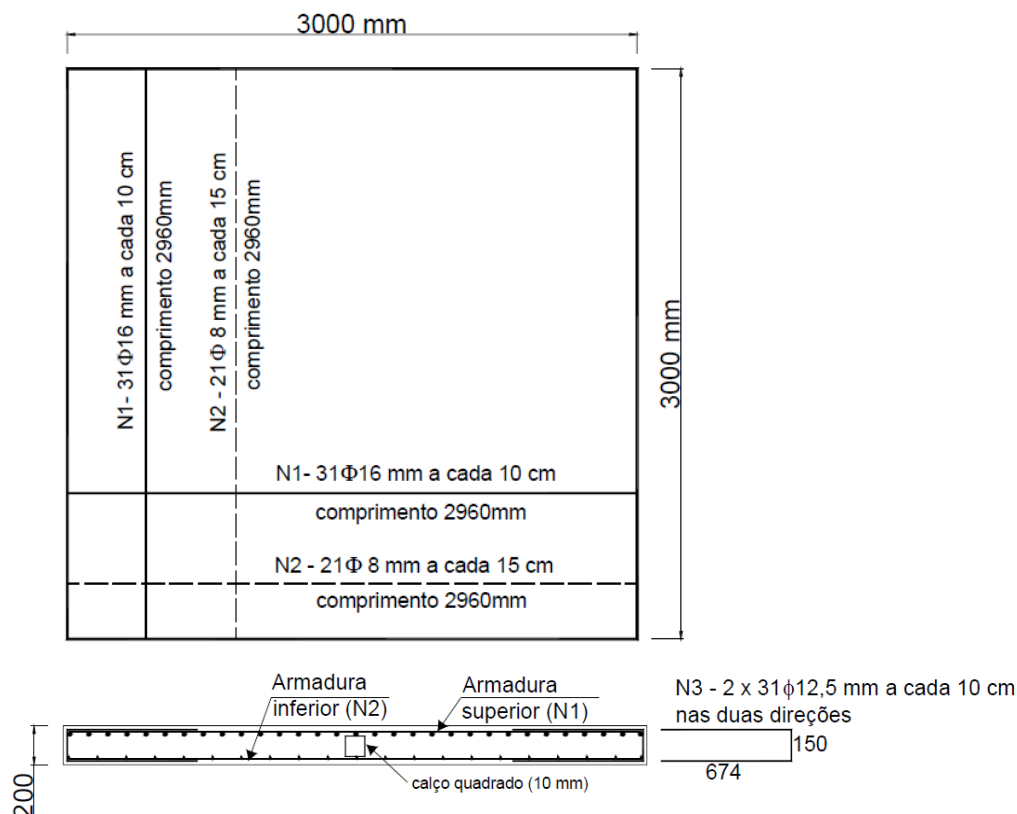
Detalhamento da armadura de flexão, a) Desenho em planta, b) Desenho em corte.
